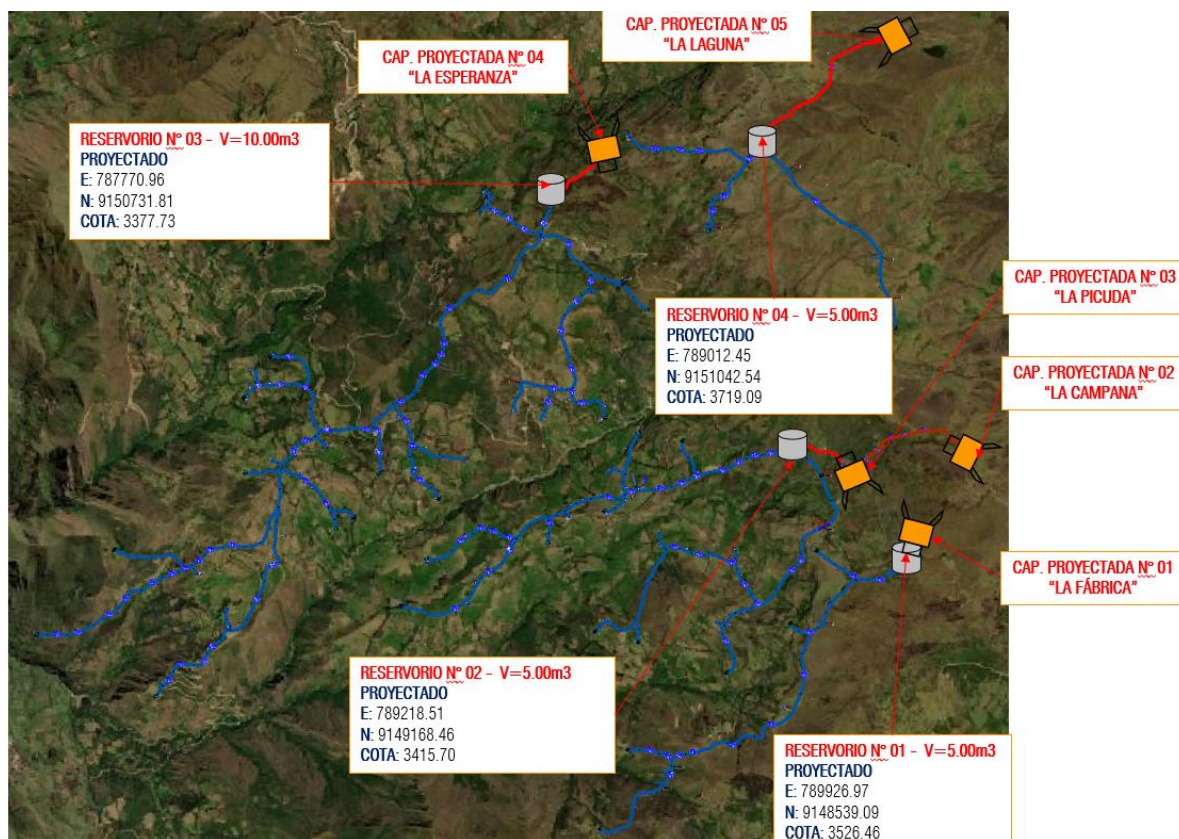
Croquis del planteamiento general proyectado del sistema de agua potable - Pauganche.
